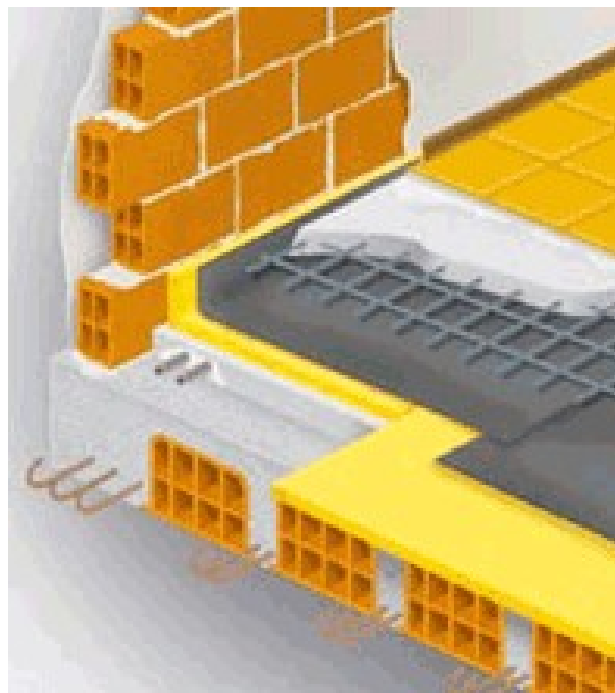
Esempio di isolamento di un pavimento: l'isolante è applicato tra la soletta portante e il massetto di ripartizione (Fonte: Isover ©)
